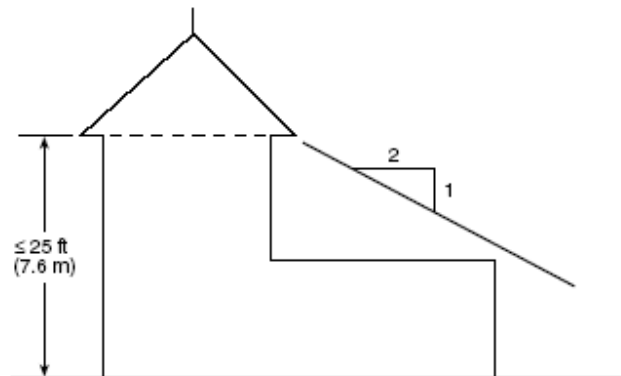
Protección de techo inferior en edificio de techo inclinado con altura $\leq 7,6$ m.
